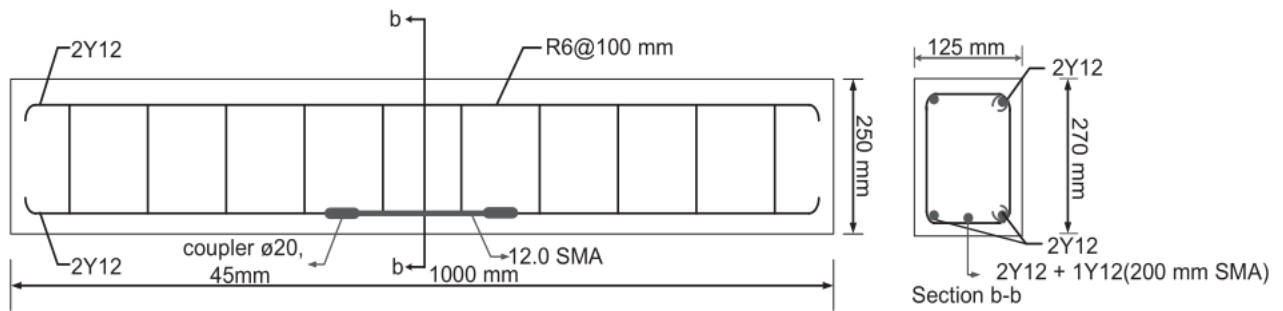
Схема залізобетонної балки з СПФ-вставкою взірця [108]
